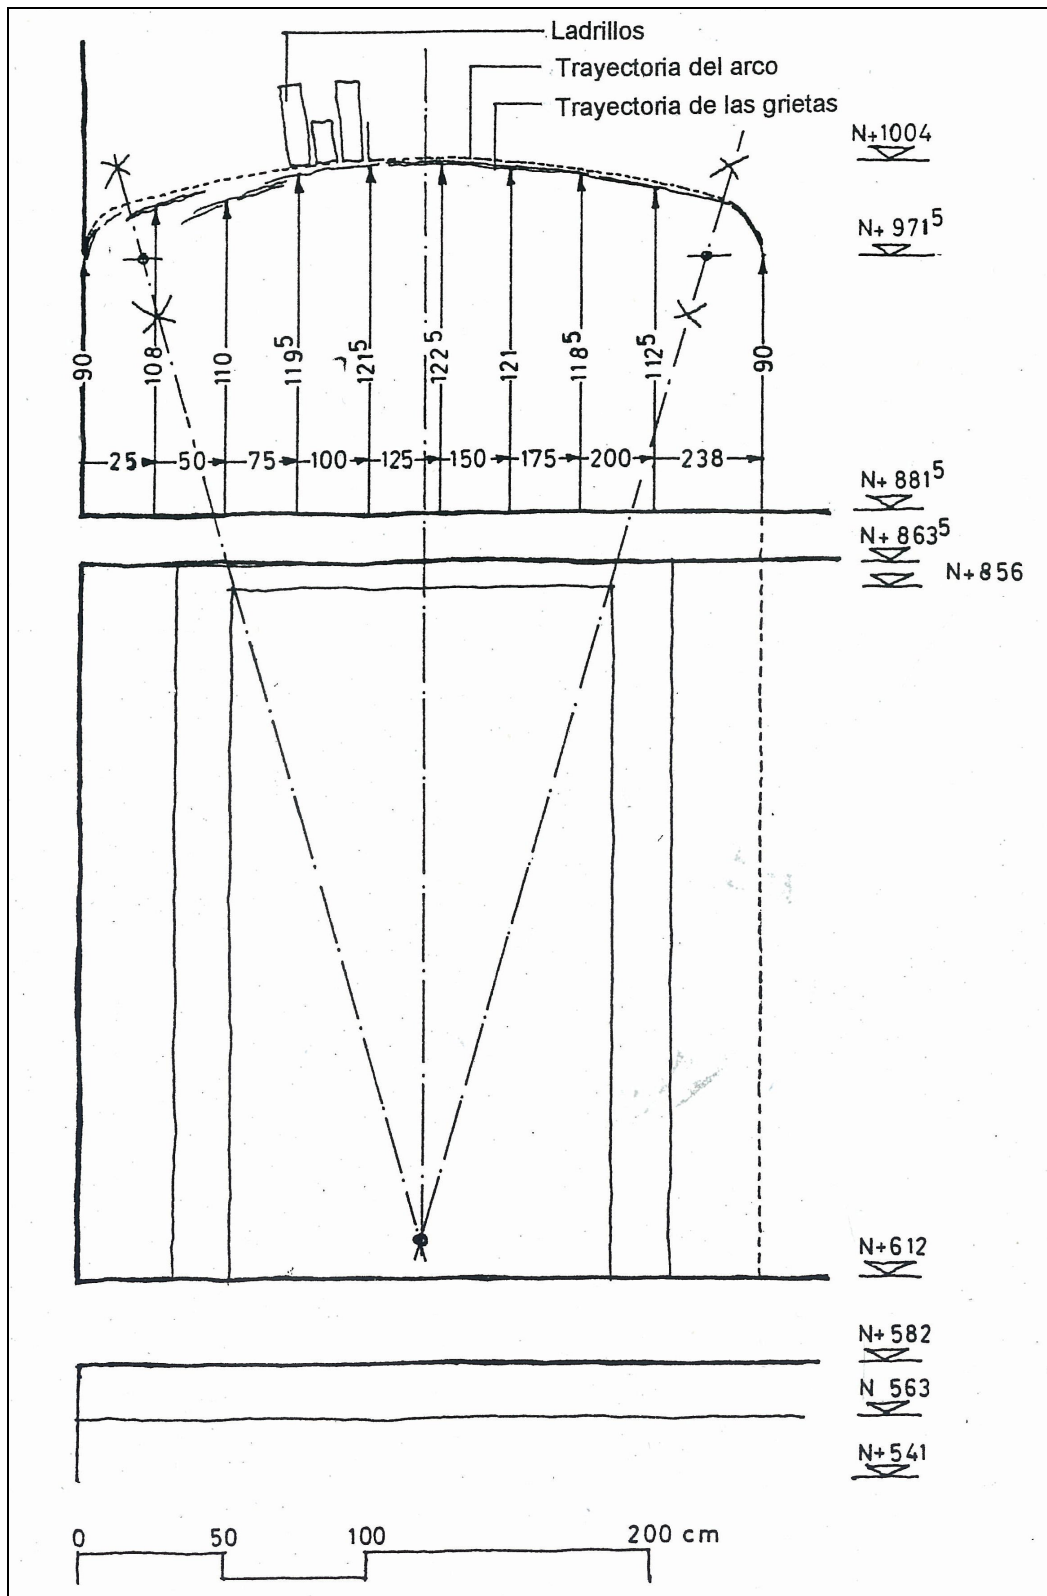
Reconstrucción del derrame de la puerta del balcón central
